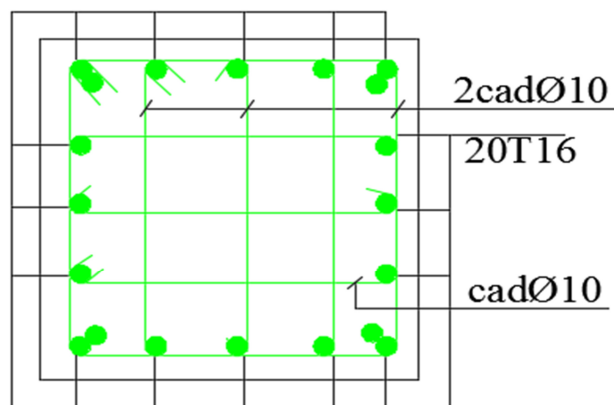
Schéma de ferraillage de poteau (45X45) cm
